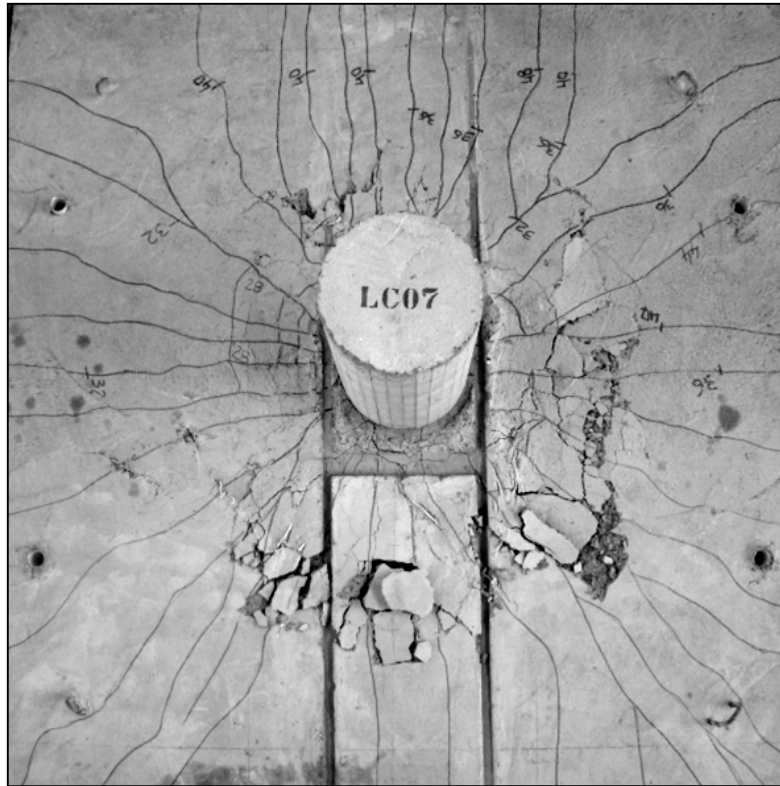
Mapa de fissuração da laje LC07
